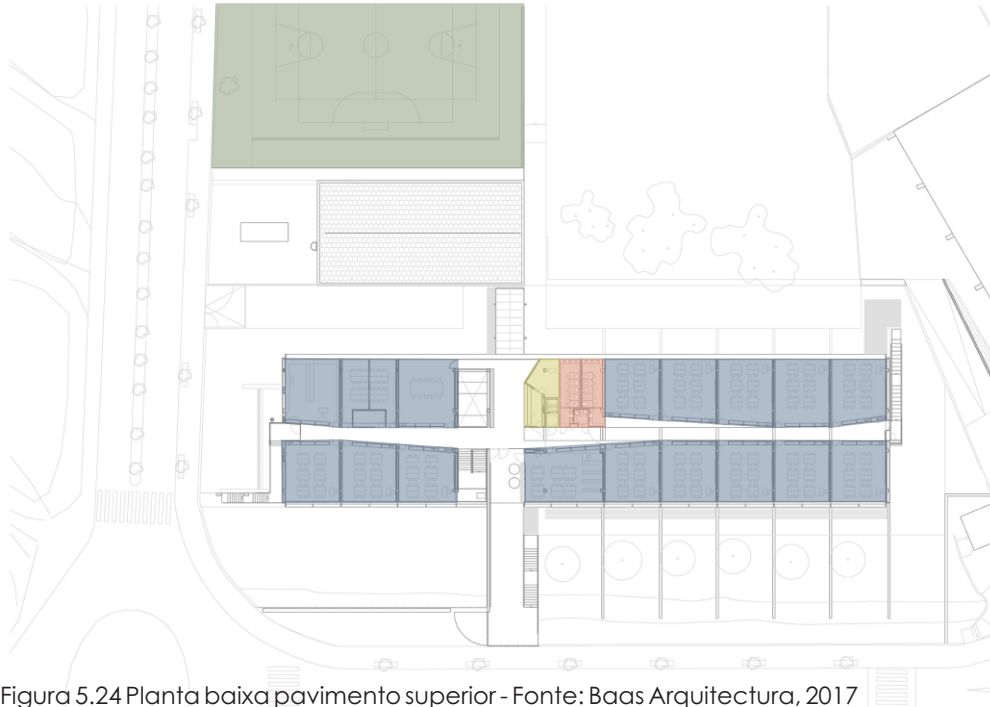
Planta baixa pavimento superior - Fonte: Baas Arquitectura, 2017
